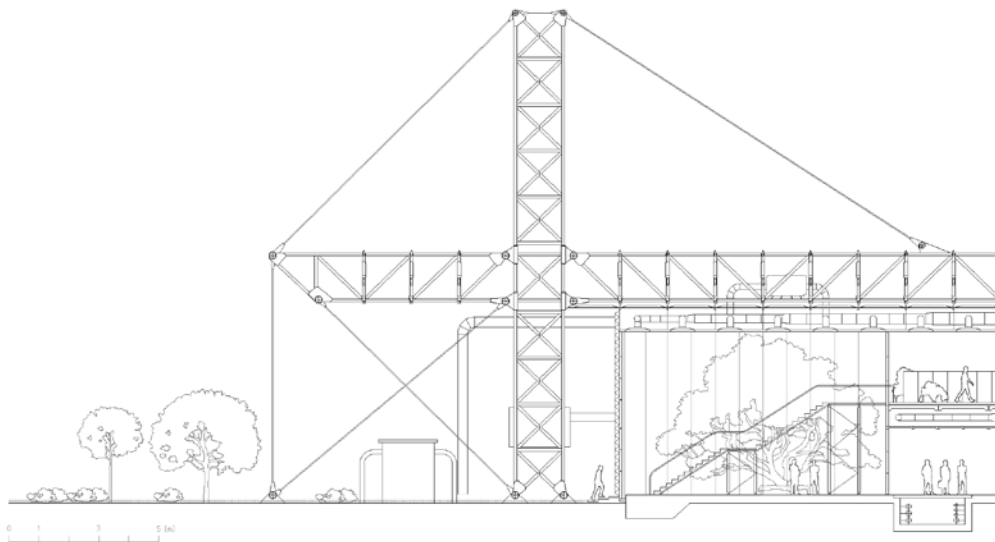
Sección detallada; la estructura queda completamente al exterior, y la fachada, la cubierta y las instalaciones se suspenden de ella. Fuente: Elaboración propia.
